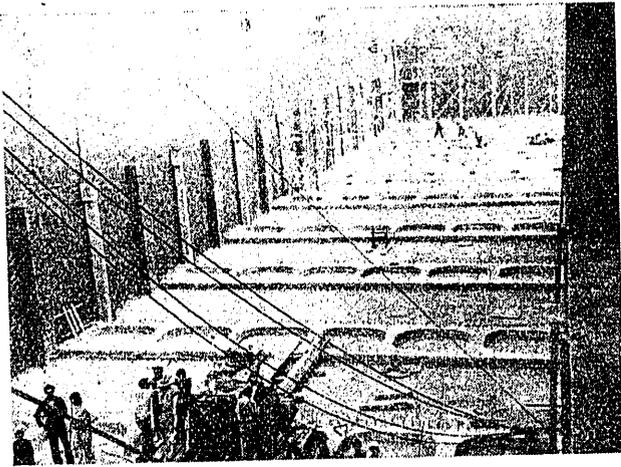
Detalles de la viga Vierendel de la torre de mando.
